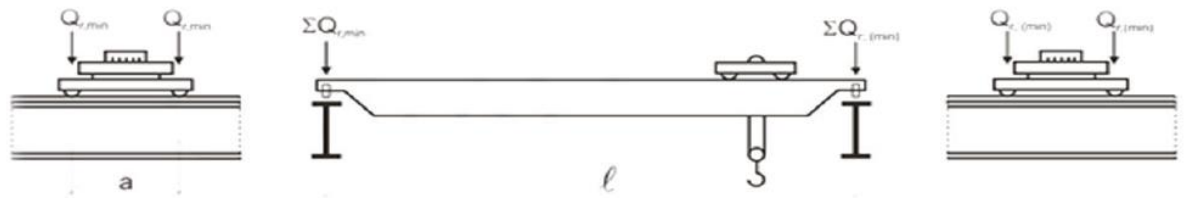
Dispositions de charge de l'appareil de levage à vide pour obtenir un chargement minimal sur la poutre de roulement
